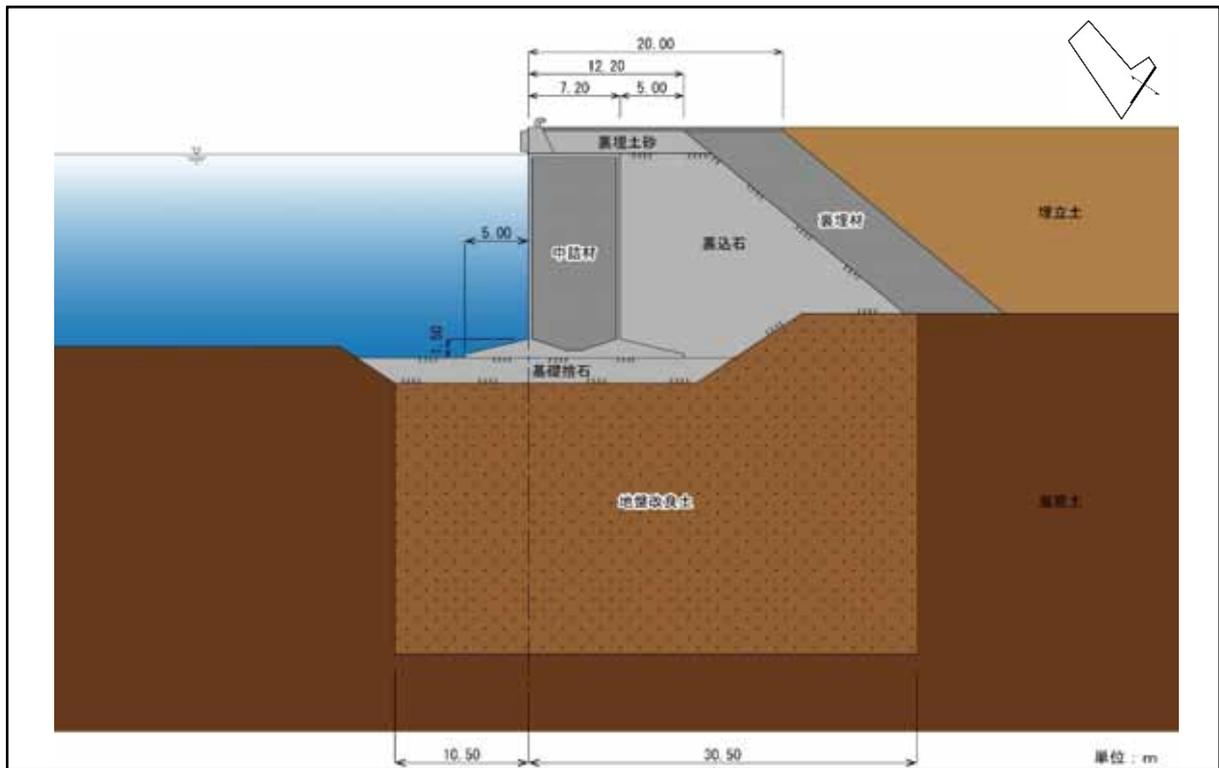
(3) 耐震強化岸壁の標準断面図
